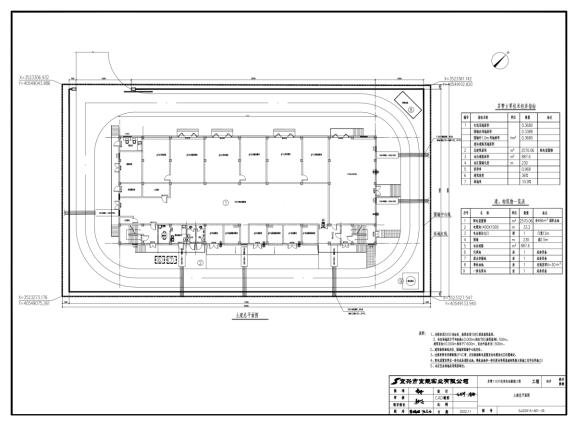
苏墅 110 千伏变电站工程总平面布置图
